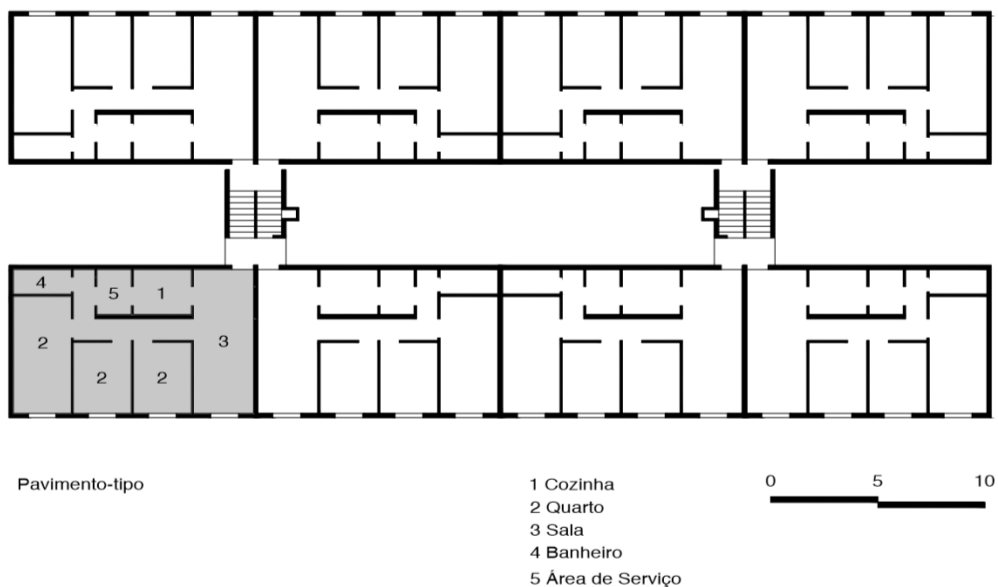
Conjunto Novo Mundo: pavimento tipo.
